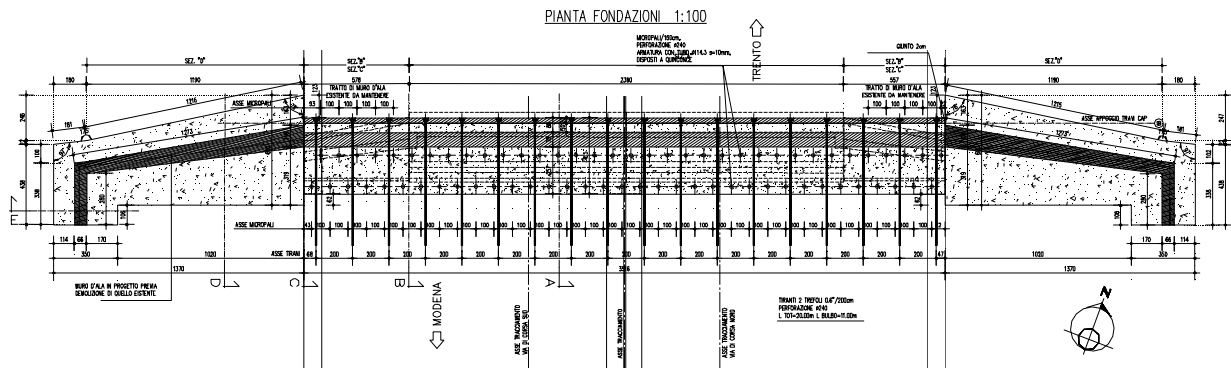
Spalle - Pianta delle fondazioni
